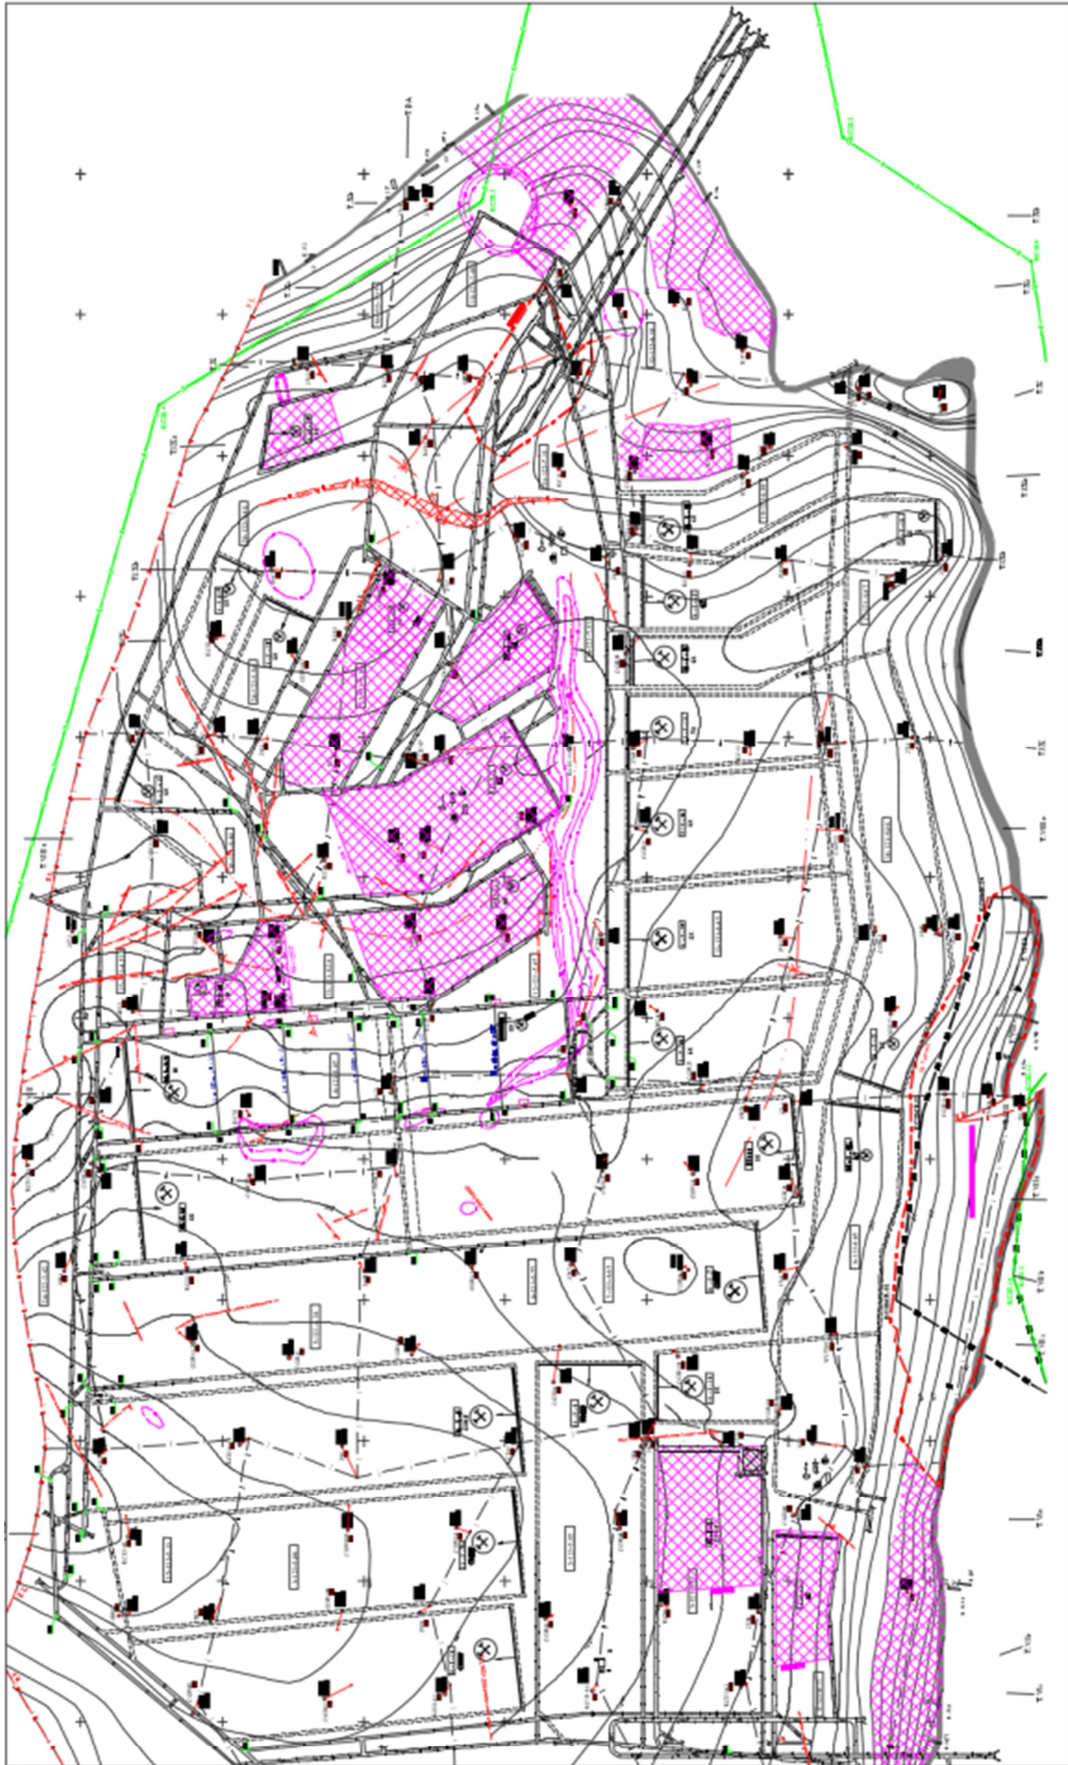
Выкопировка из плана горных выработок по угольному пласту 14–5 (шахта «Хечам»)
